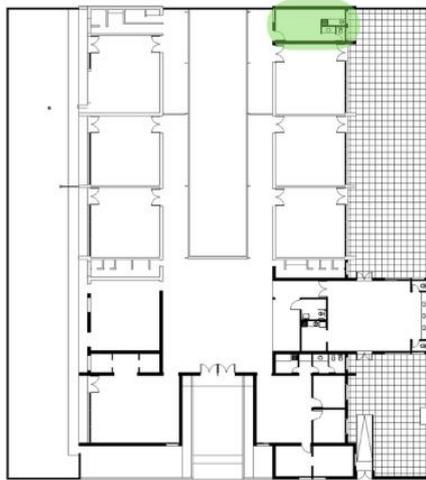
Anteproyecto arquitectónico: comedor – ubicación.
